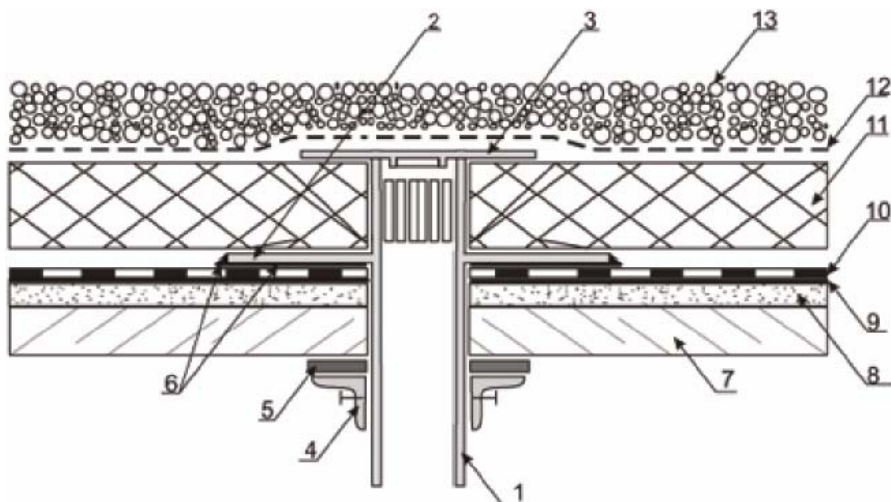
Примыкание кровли к водоприемной воронке для инверсионной кровельной системы. (Неэксплуатируемое покрытие).
